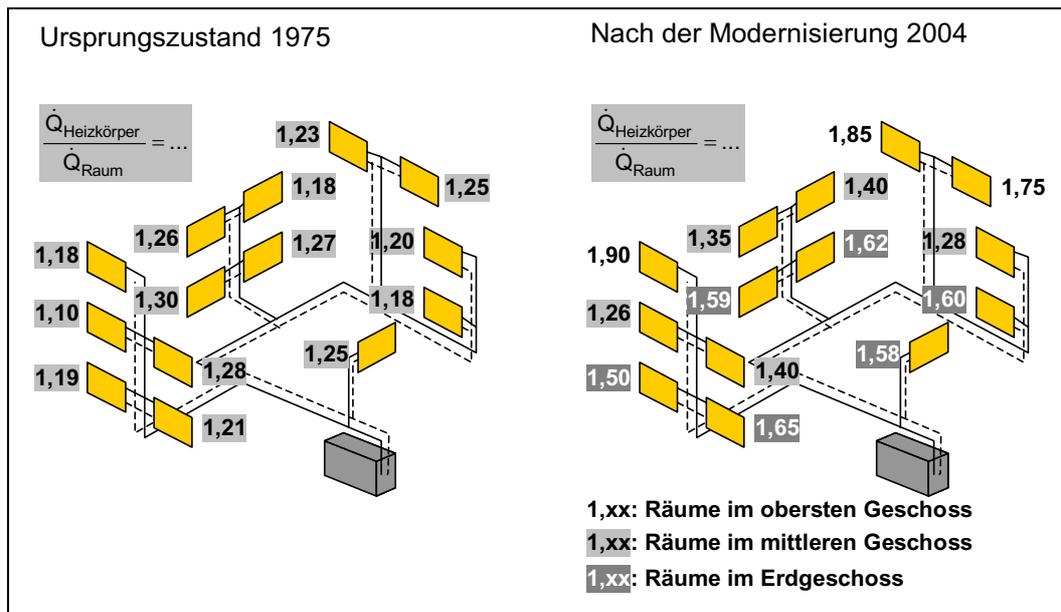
Heizkörperdimensionierung vor und nach einer Modernisierung
